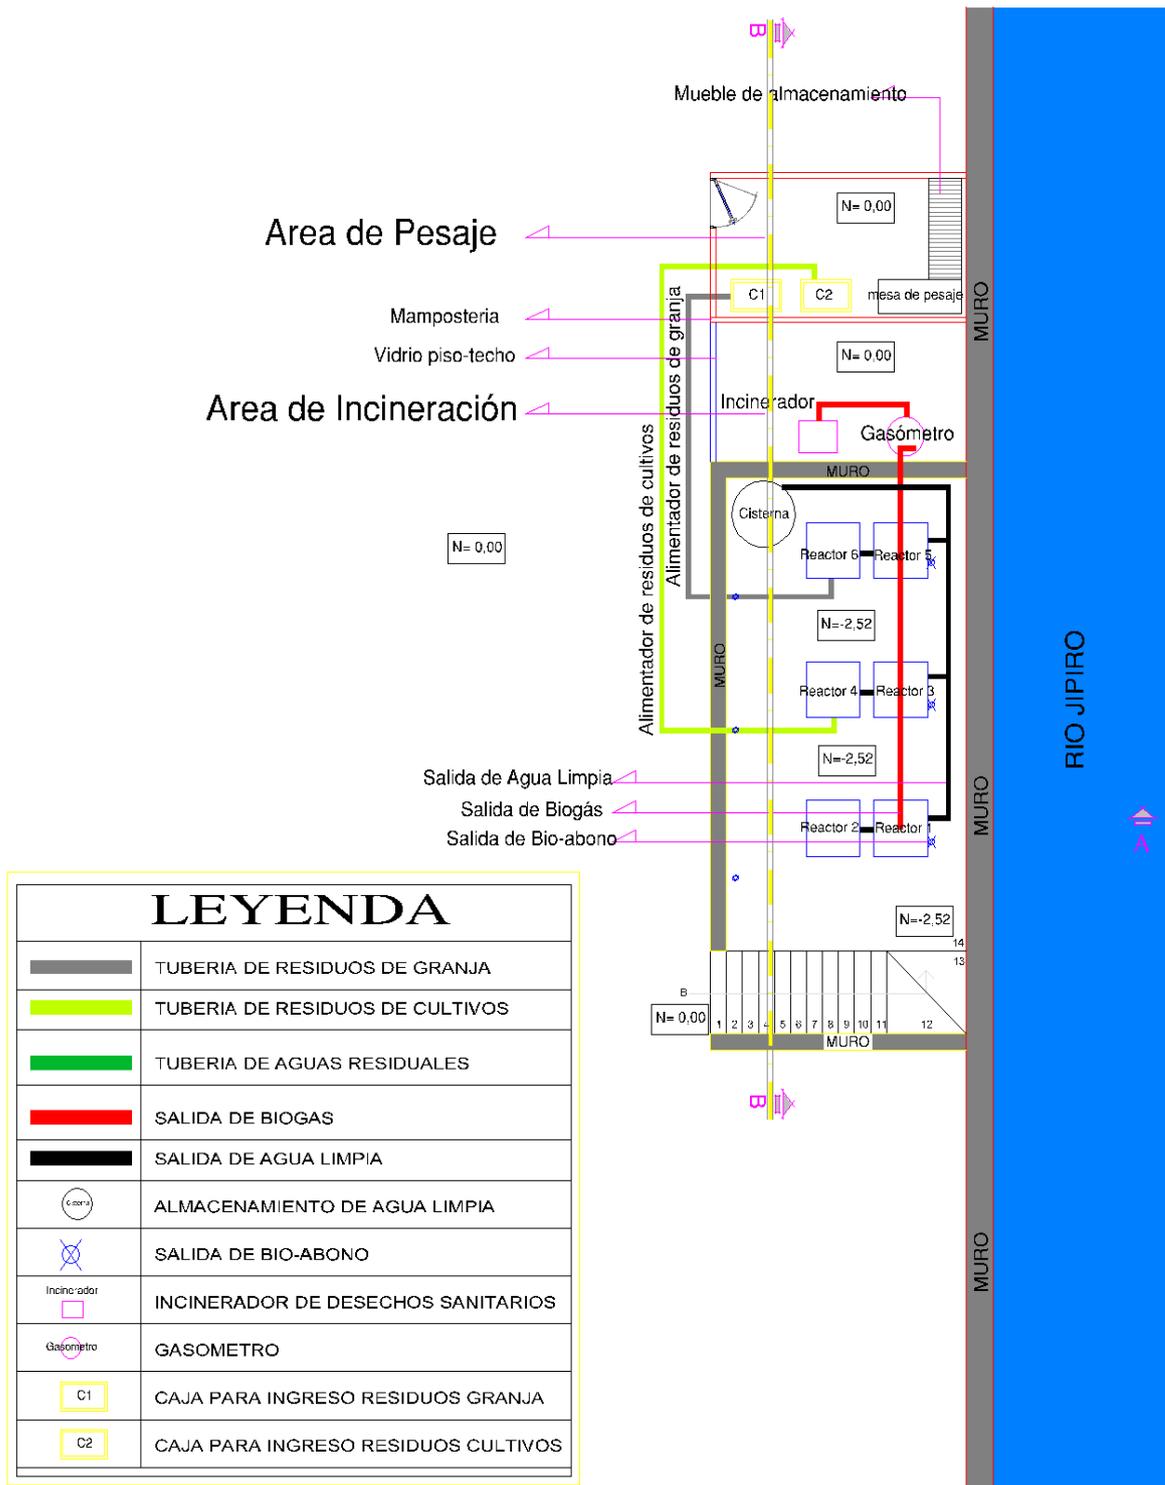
Vista de planta de la obra civil propuesta para el emplazamiento del sistema de biodigestores en el PRJ. Diseño de autores
